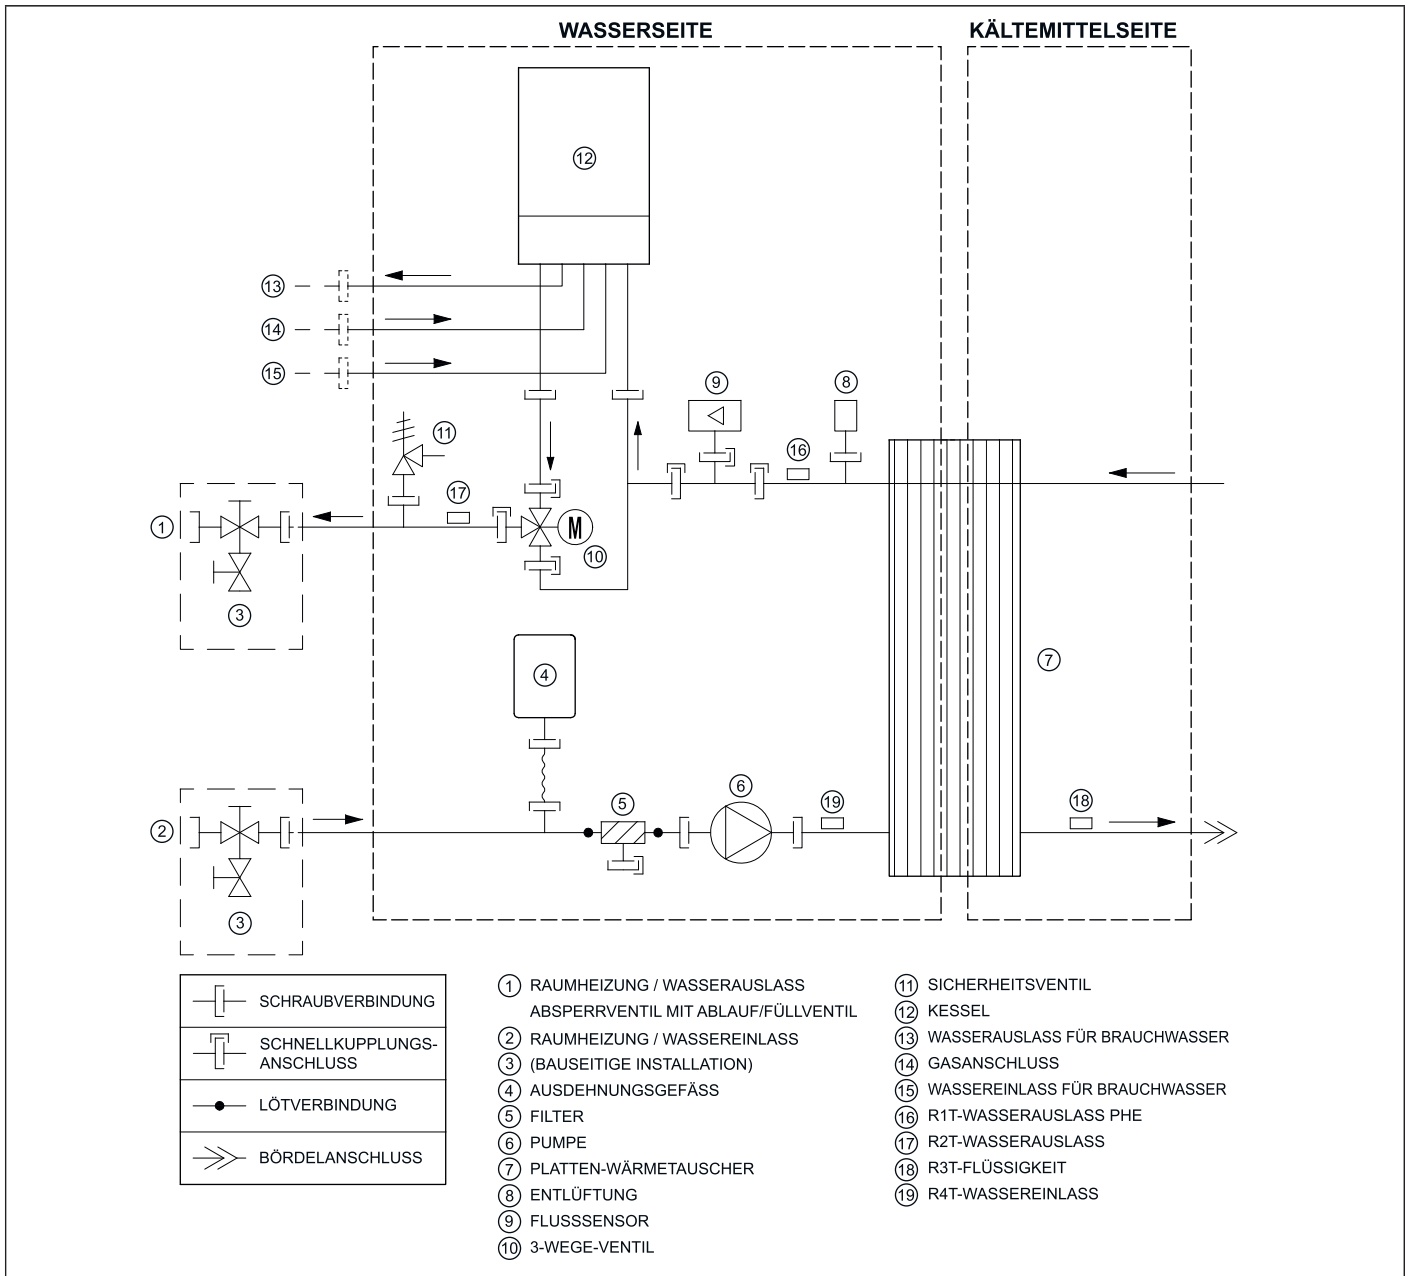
Kältetechnischer und hydraulischer Aufbau - Innengeräte HPU hybrid 5/8 kW
